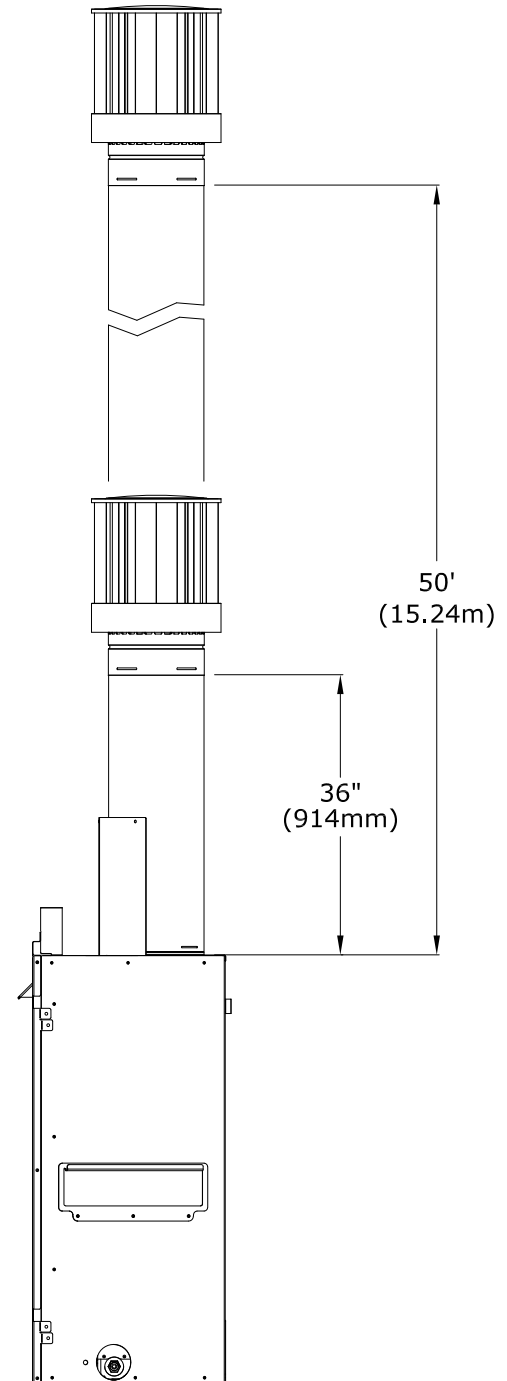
Conduit 4"x6-5/8" à terminaison verticale
